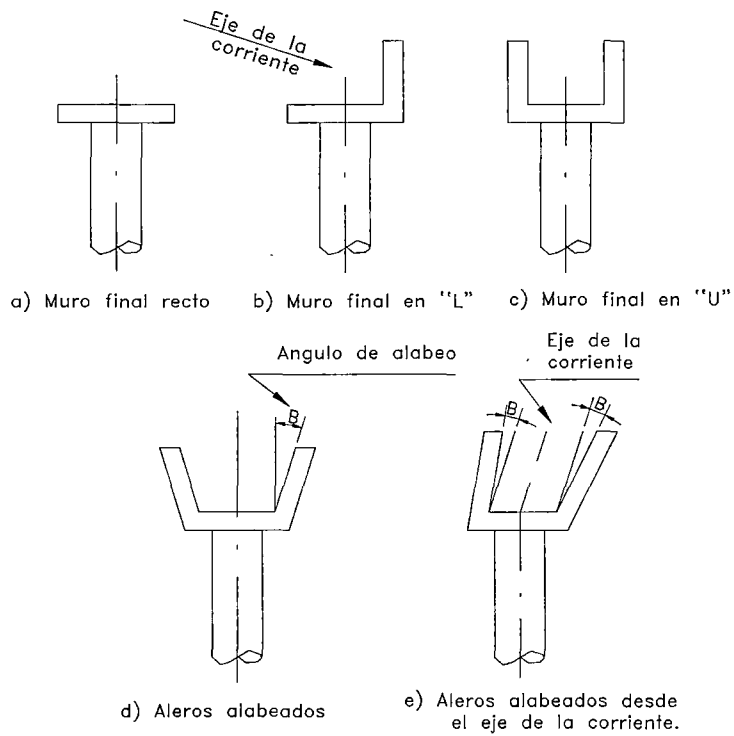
Muros Finales y Aleros de Alcantarillas.
